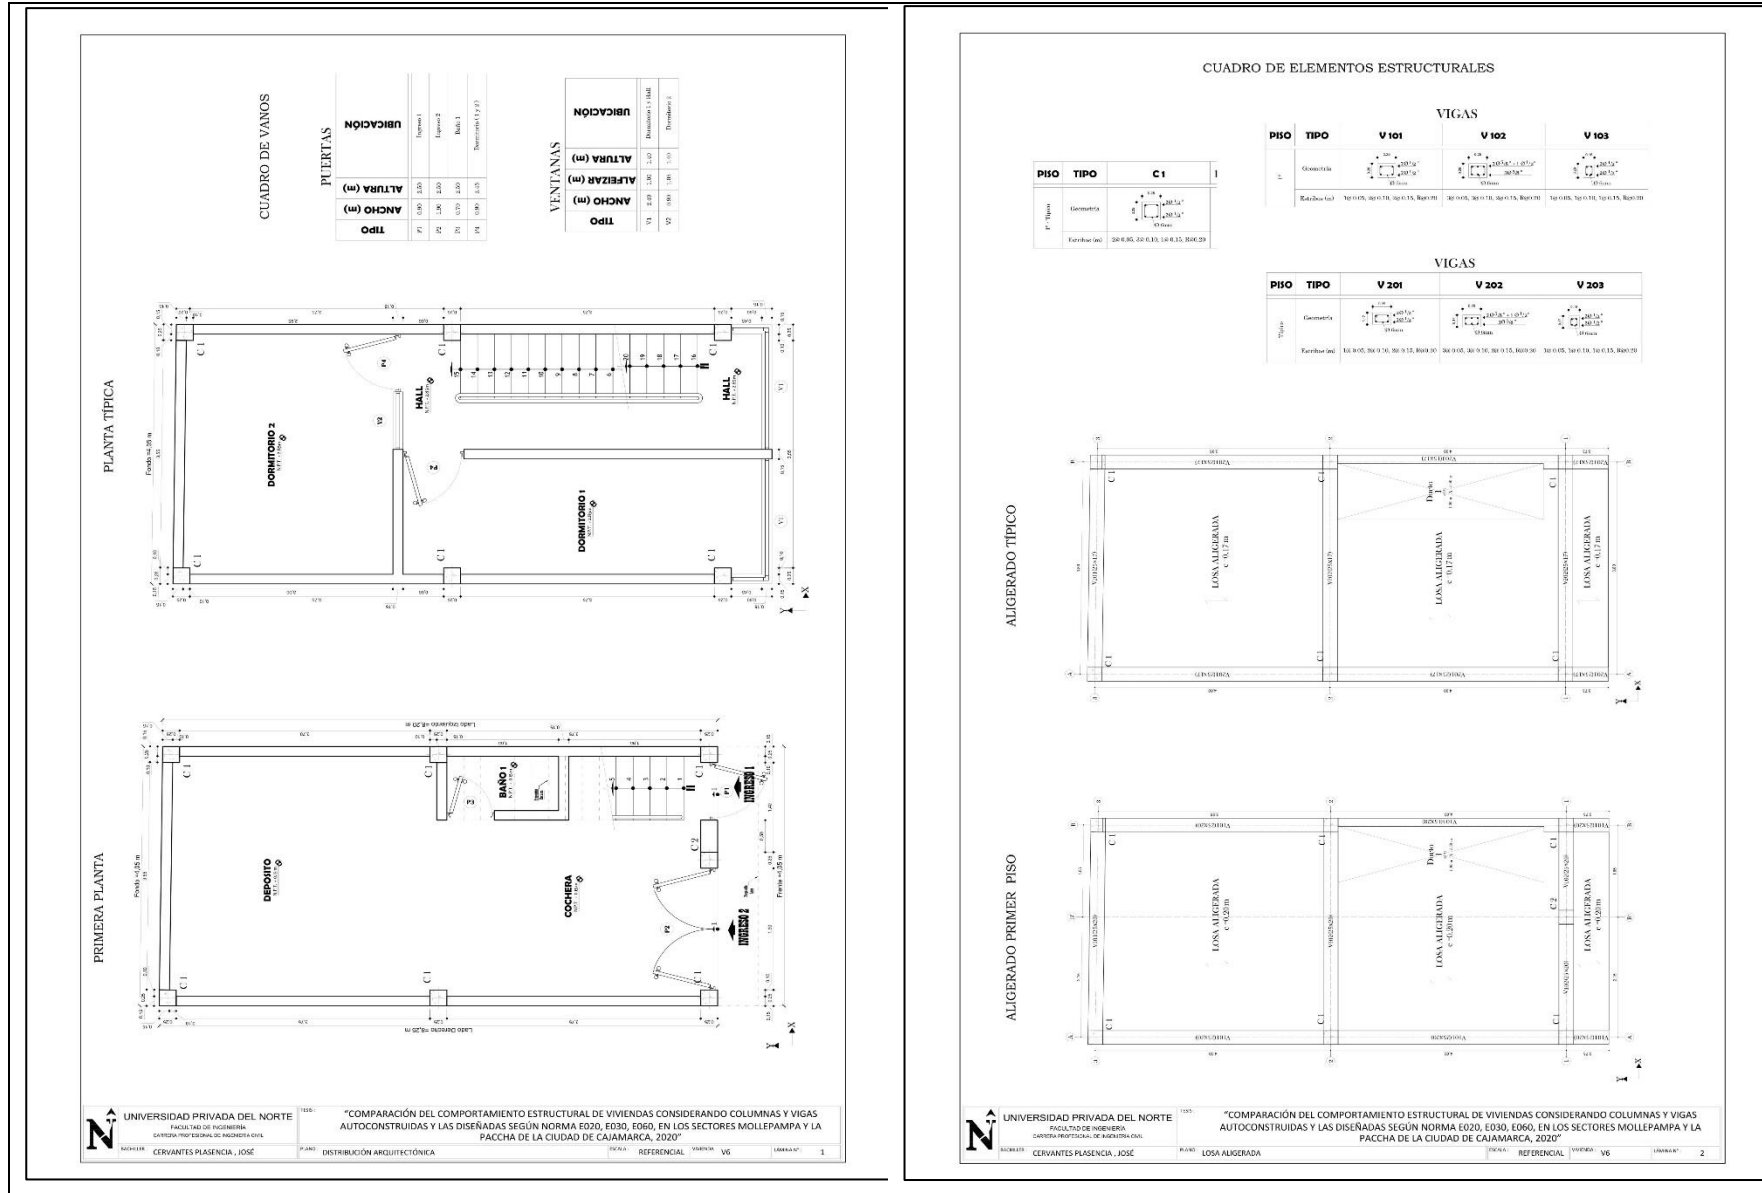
Planos de arquitectura y losa aligerada vivienda 6
